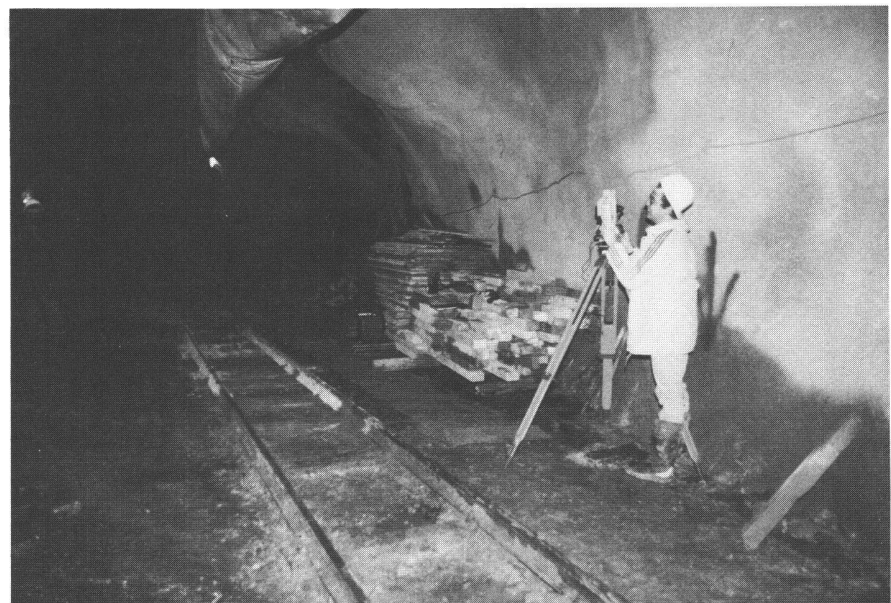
Piquetage du tunnel: les travaux du géomètre.
